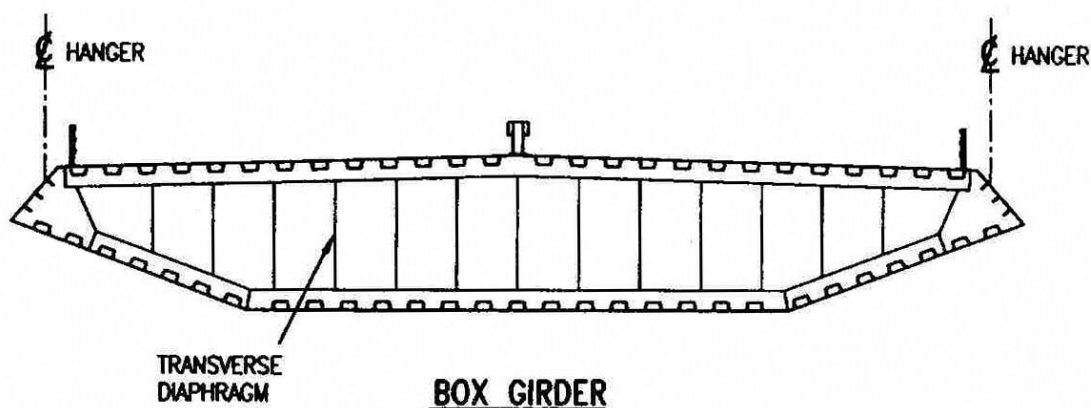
Tablero de sección cajón (Ryall MJ)
